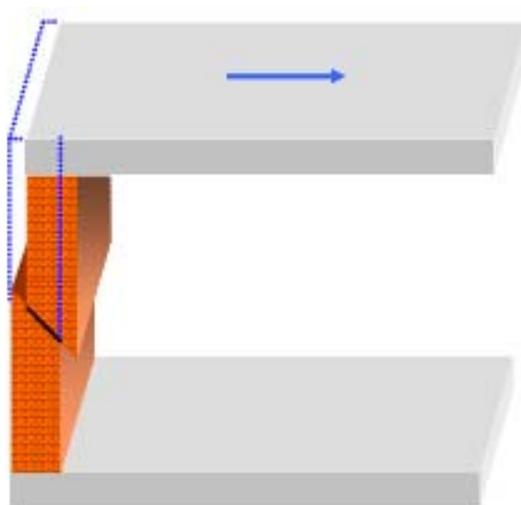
Movimentação da alvenaria decorrente da retração da laje de concreto. (Fonte: THOMAZ, 1989).
